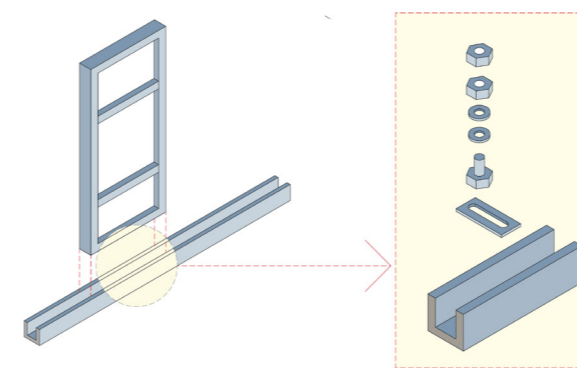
Esquema de design for dissassembly (DfD) o diseñar para desmontar
